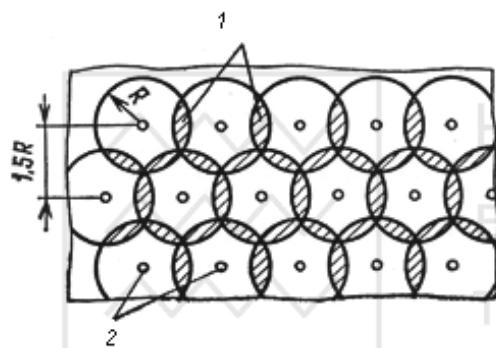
Схема перекриття зон ущільнення бетонної суміші:
